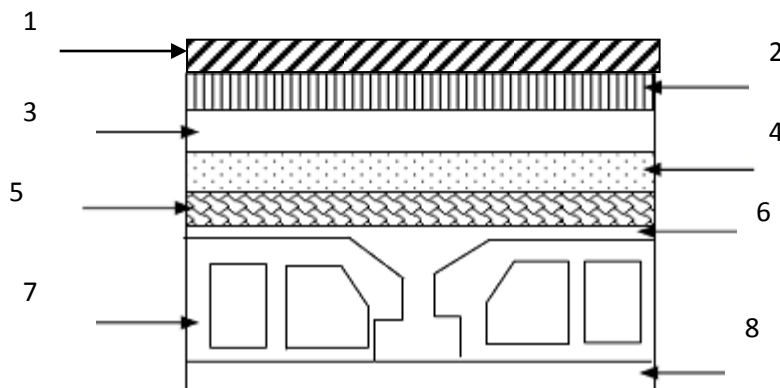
Constituant d'un plancher terrasse inaccessible
